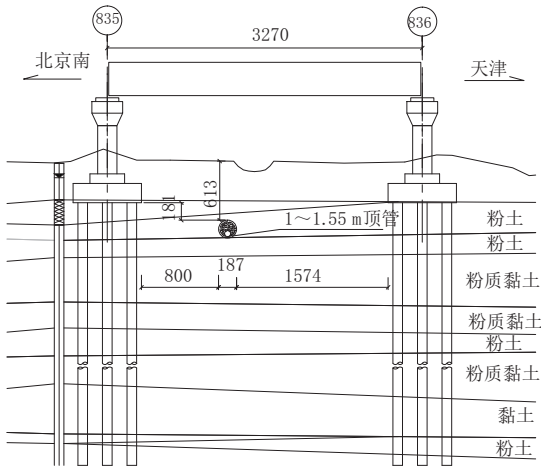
京津城际铁路杨村特大桥与钢筋混凝土顶管剖面位置关系图(单位:cm)
